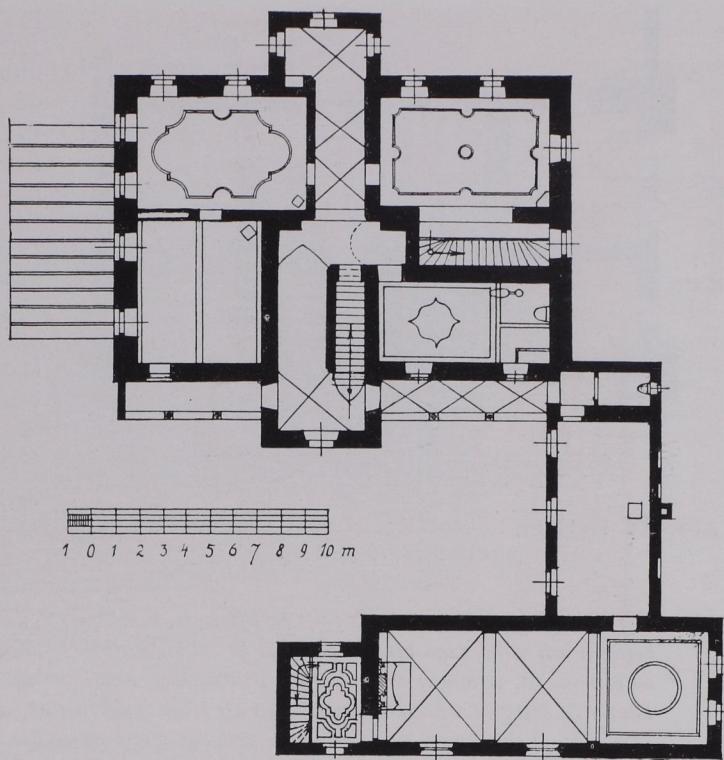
Schloß Haunsberg, Grundriß 1:300 (S. 161).
